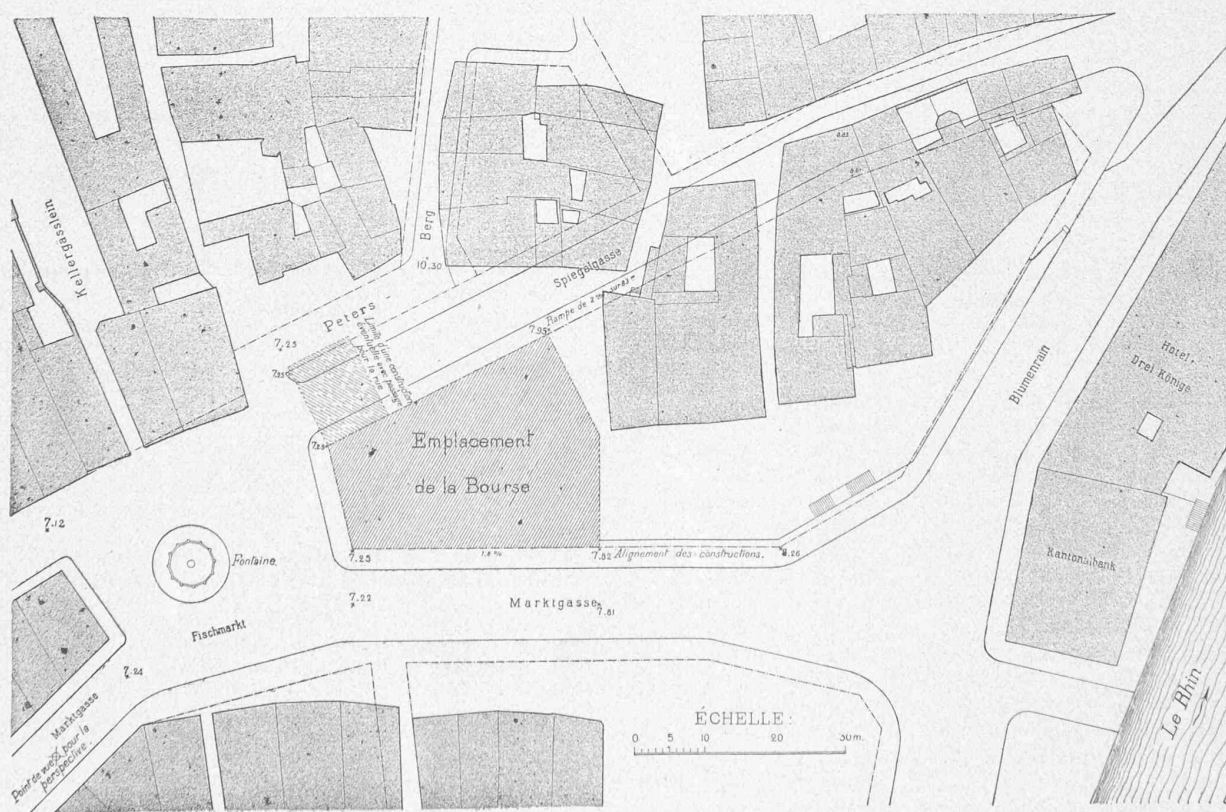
Plan de situation du bâtiment de la Bourse à construire sur le Marché aux poissons, à Bâle.
